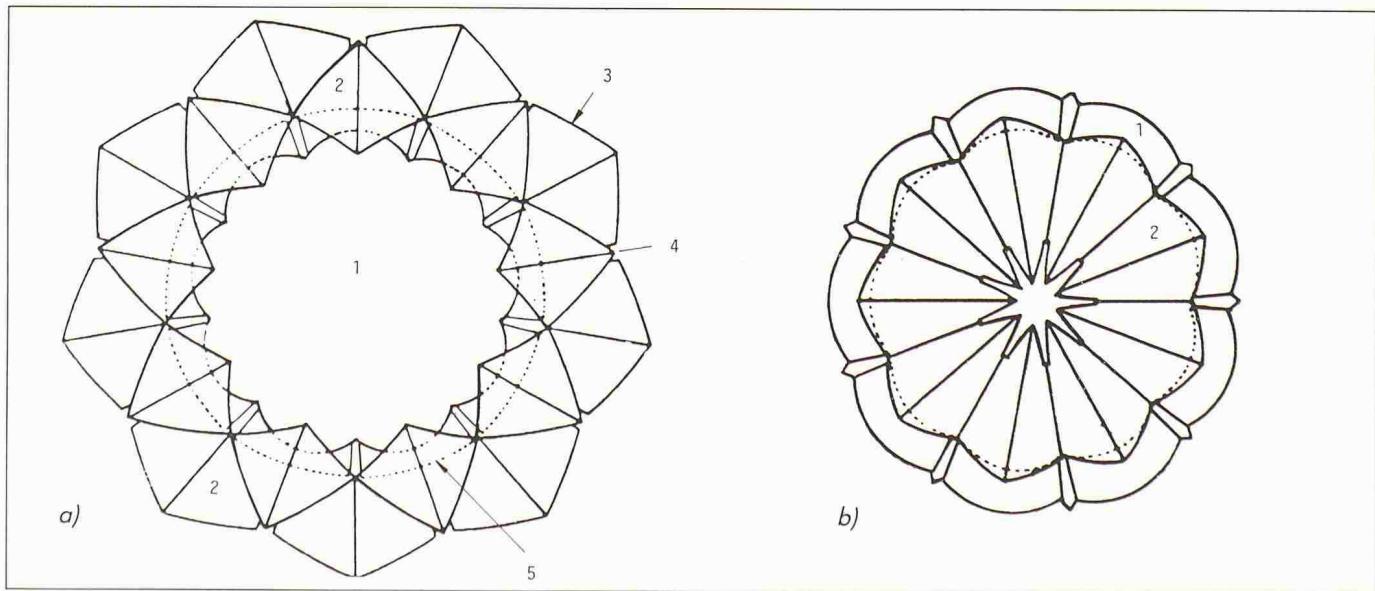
Anordnung der Blütenblätter und Massivbögen: a) 1. Zentralhalle 2. Äussere Halle 3. Eingangsblatt 4. Aussenblatt 5. Unterseite des Bogens b) 1. Bogen 2. Innenblatt
